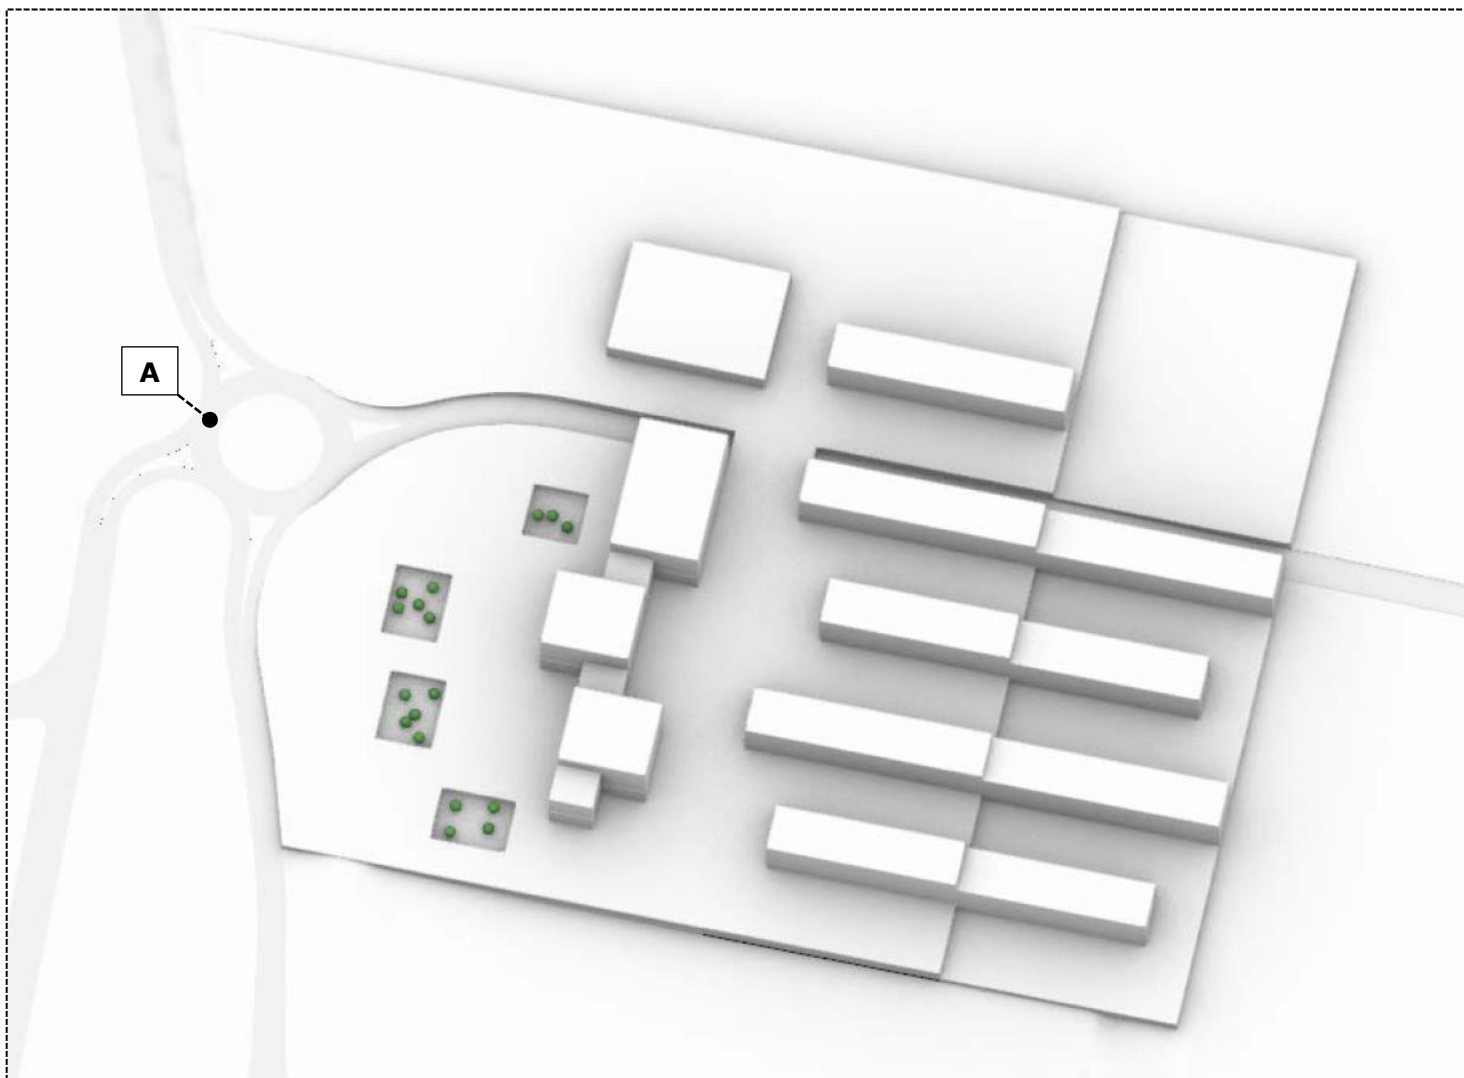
Lay-out planimetrico schematico di progetto del comparto
